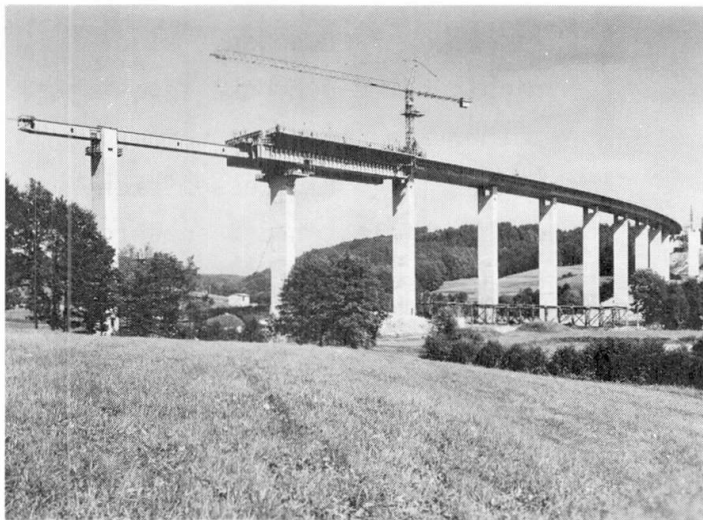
Feldweiser Vorbau mit Vorschubrüstung
